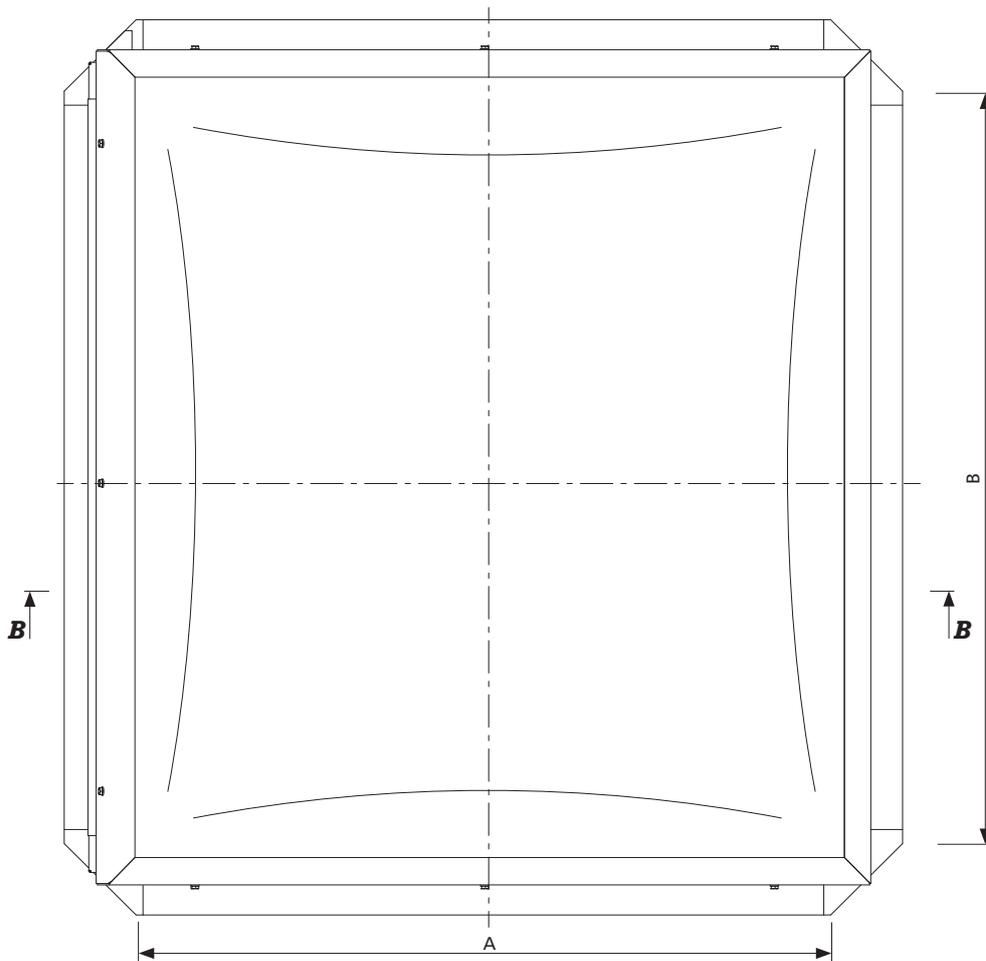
Vue de haut d'un lanterneau d'aération mcr PROLIGHT E, dimensions en mm
